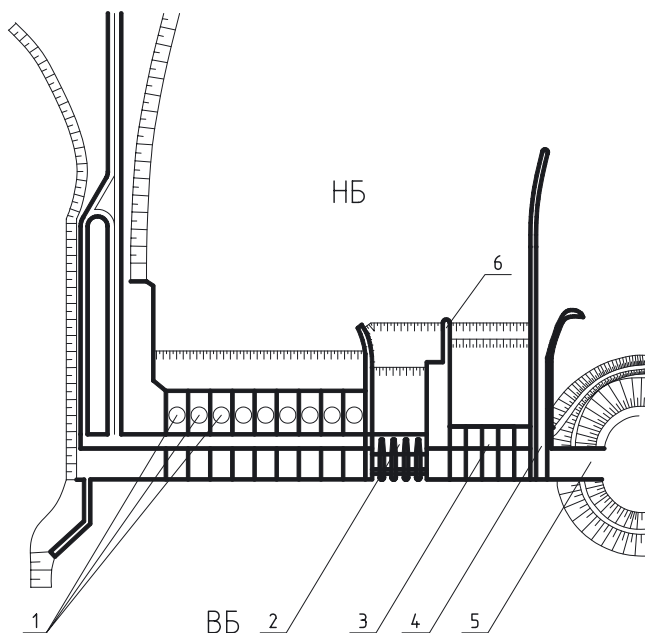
Компонка водопропускных сооружений Богучанского гидроузла: 1 – гидроэлектростанция; 2 – поверхностный водосброс №2; 3 – глубокий водосброс №1; 4 – лесопропускное сооружение; 5 – грунтовая плотина; 6 – разделительная стенка между водосбросами 1 и 2
